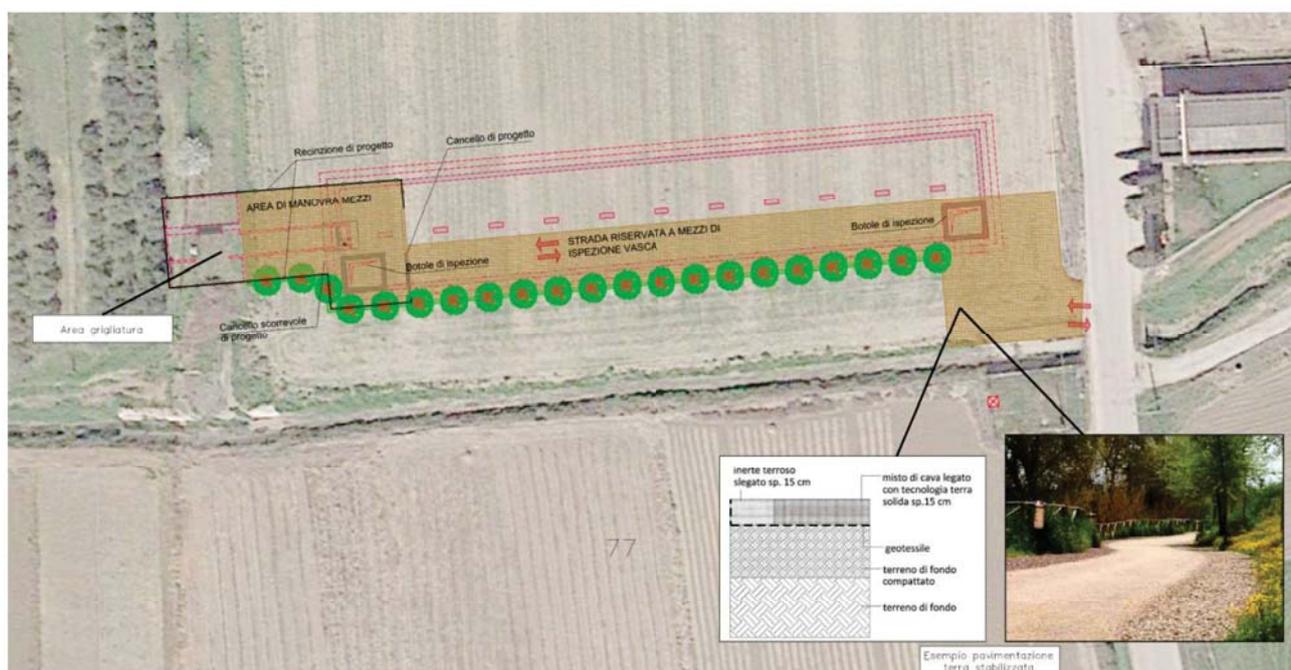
Stralcio planimetrico sistemazioni esterne con pista accesso in terra stabilizzata
